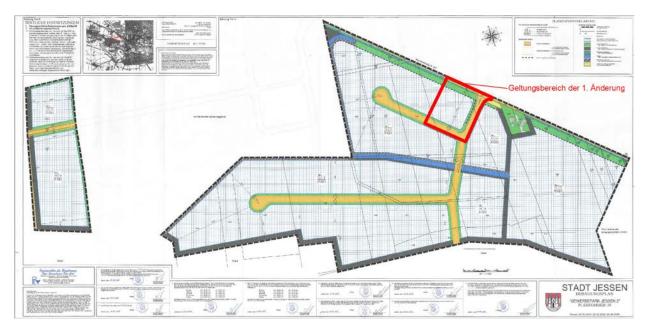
Abgrenzung Geltungsbereich 1. Änderung
